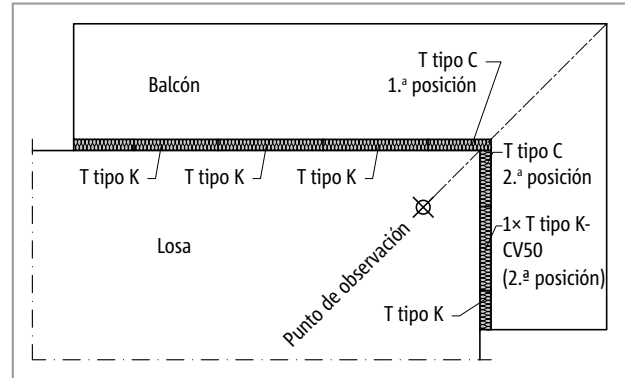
Schöck Isokorb® T tipo C: Balcón en voladizo con esquinero externo
